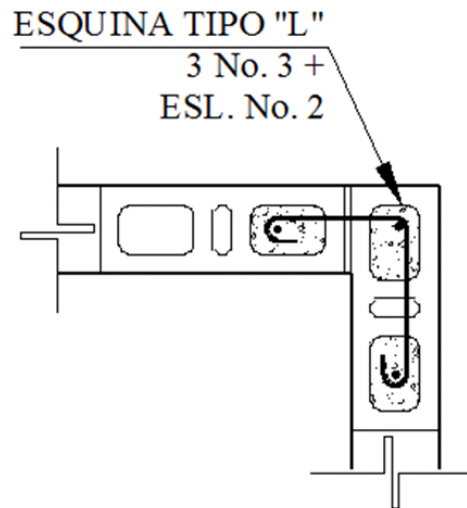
Refuerzo vertical en extremo de muro viviendas un nivel
